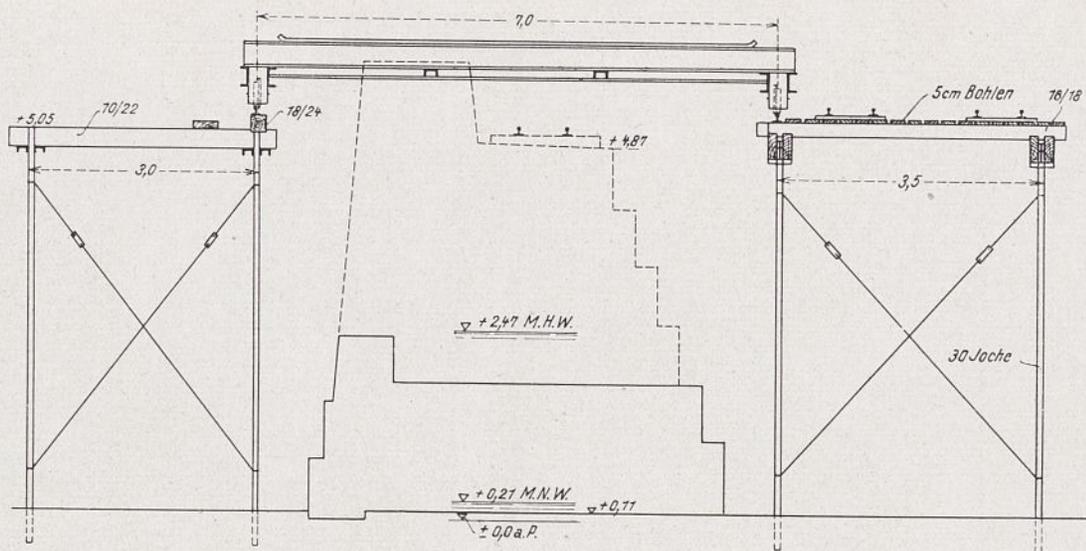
Querschnitt des Baugerüsts. M. 1:100.
